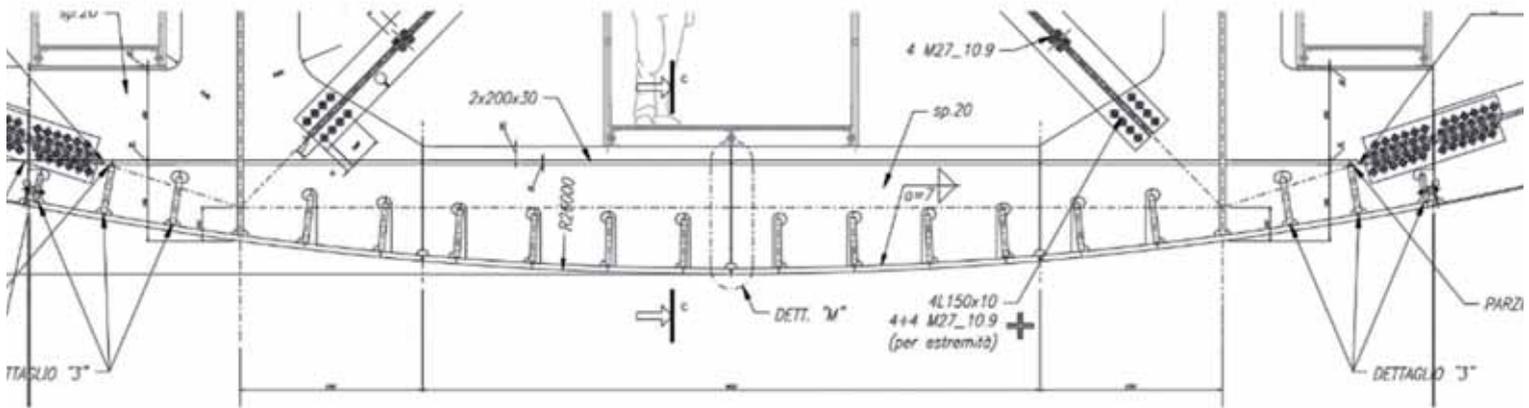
Ribb longitudinali saldati alla piattabanda superiore della trave metallica da 100 m nelle sezioni in asse pila e sul fondo del cassone in mezzeria
